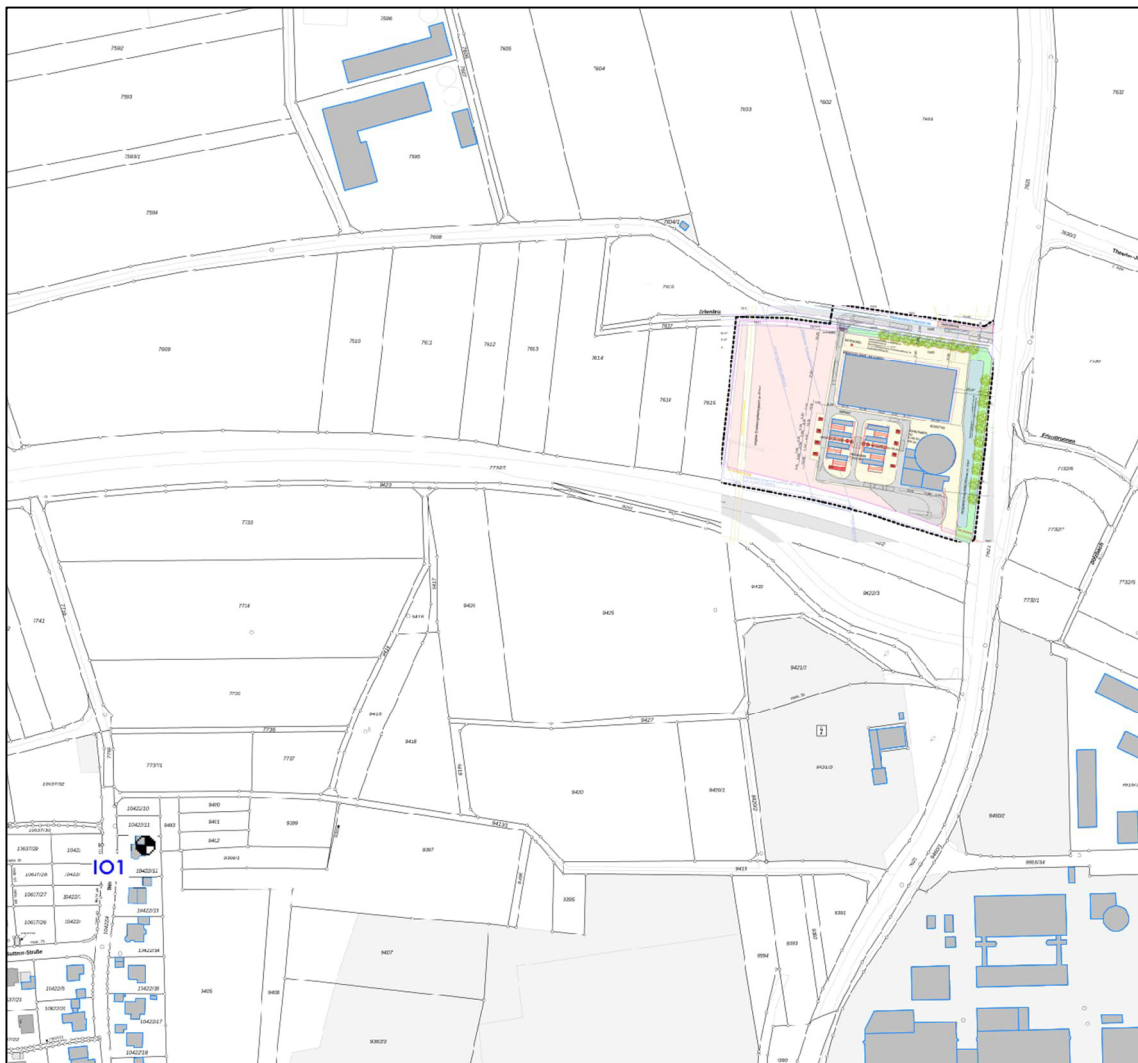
Lageplan mit Darstellung der Immissionsorte (IO)
